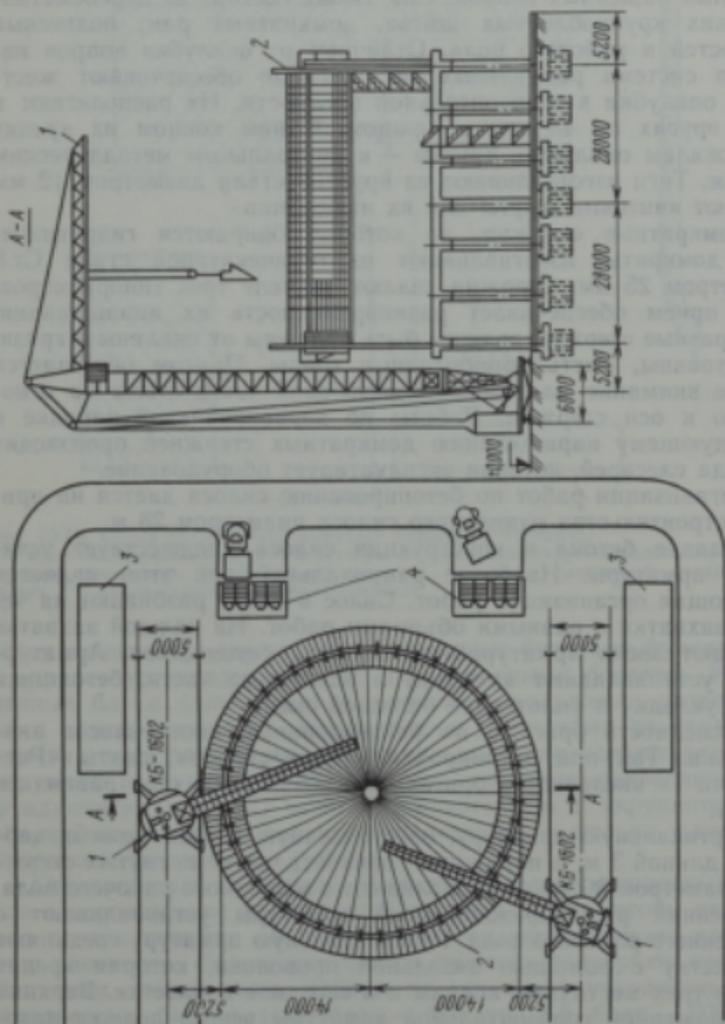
Стройгенплан при строительстве силоса диаметром 28 м:
